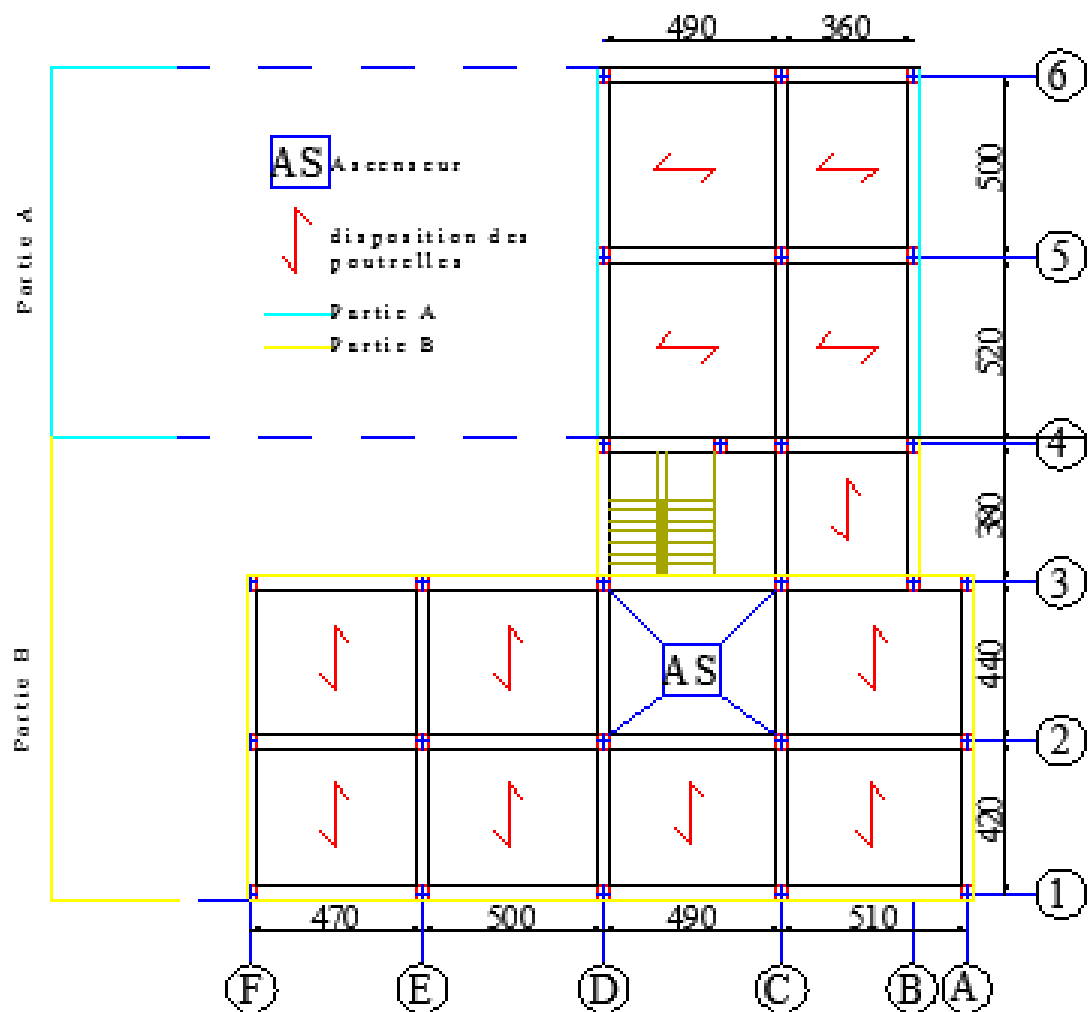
Disposition des poutrelles dans les différents Planchers.
